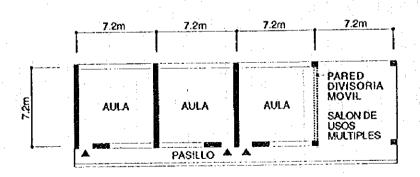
PLANTA DEL EDIFICIO DE AULAS TIPO 3-3-6
